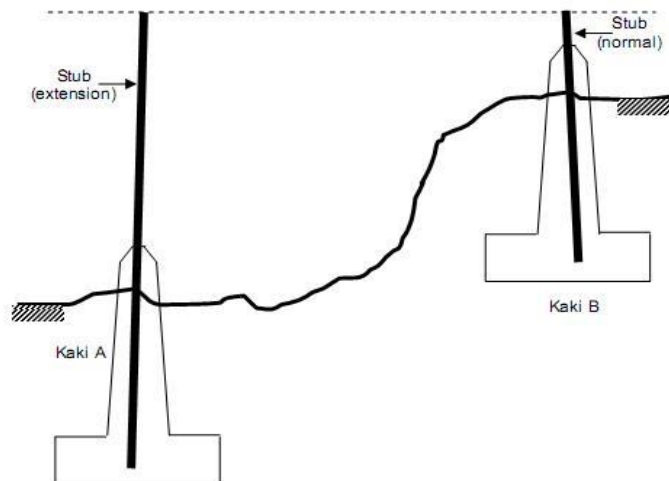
Pondasi tower (*lattice*) SUTT 500 kV
